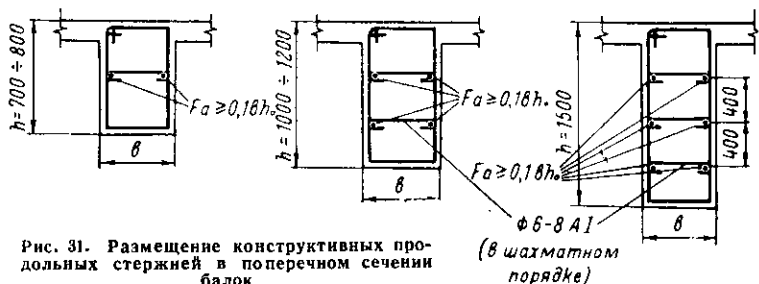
Размещение конструктивных продольных стержней в поперечном сечении балок
